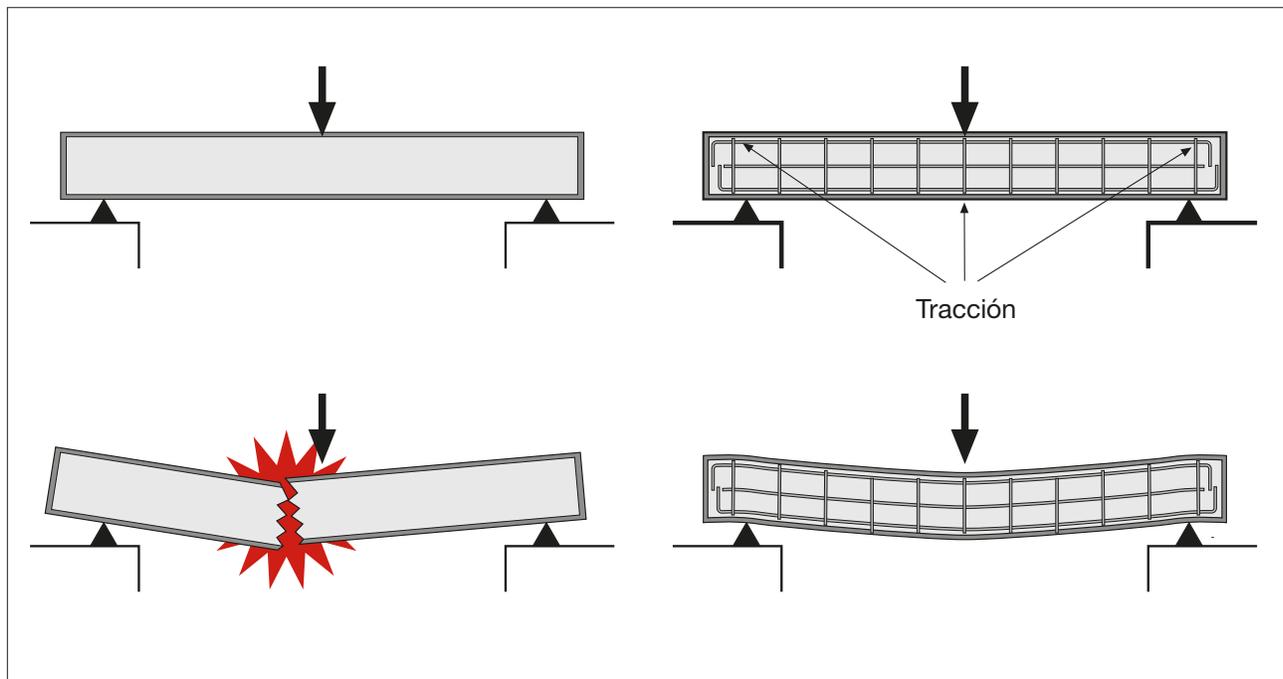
Ejemplo de viga cargada, sin y con armaduras sometidas a tensiones.
